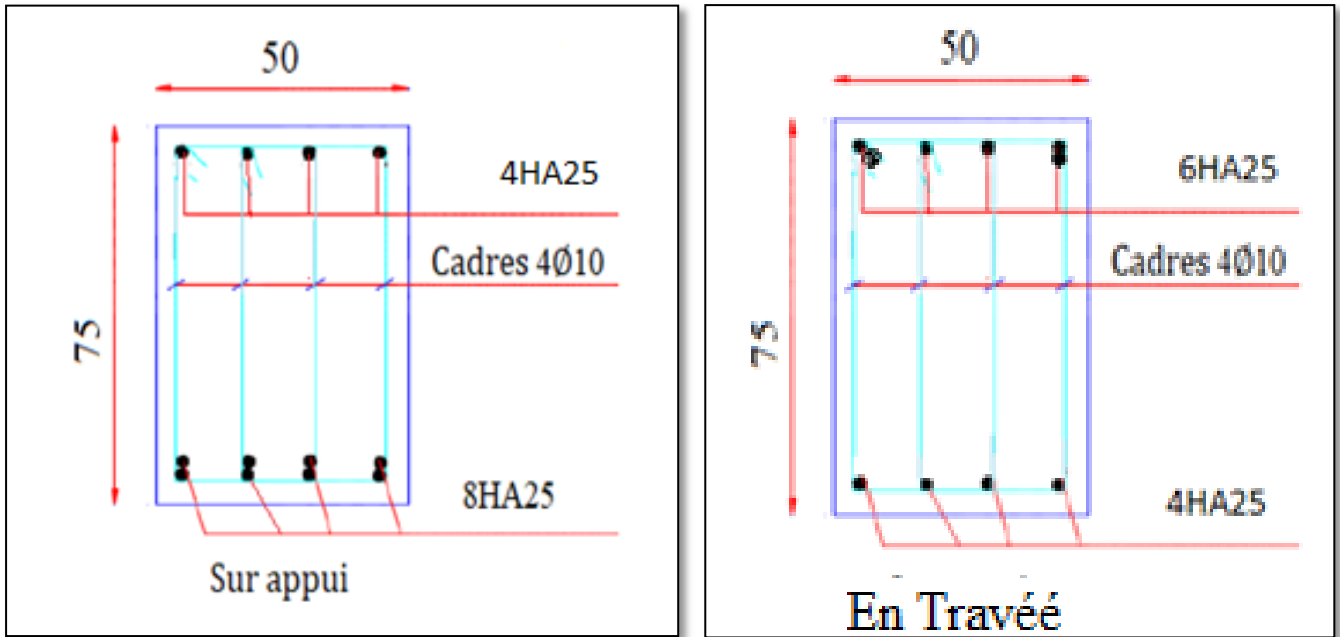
Ferrailage de la nervure. Sens X et Y
